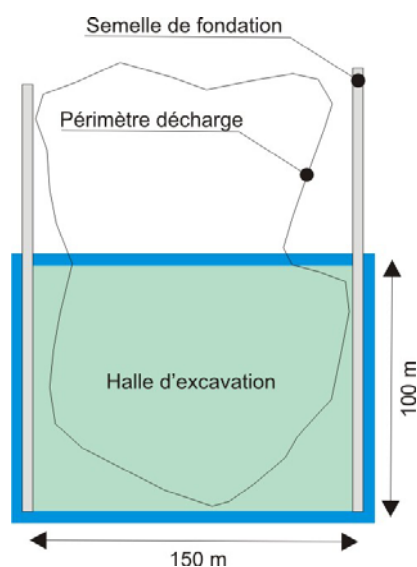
Halle d'excavation (première étape d'excavation)
